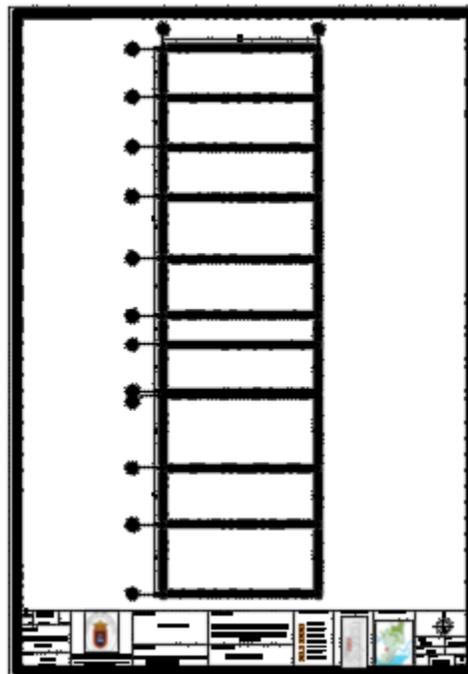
Esquema conceptual de planta estructural de cubierta bloque deportivo, recreativo y cultural
